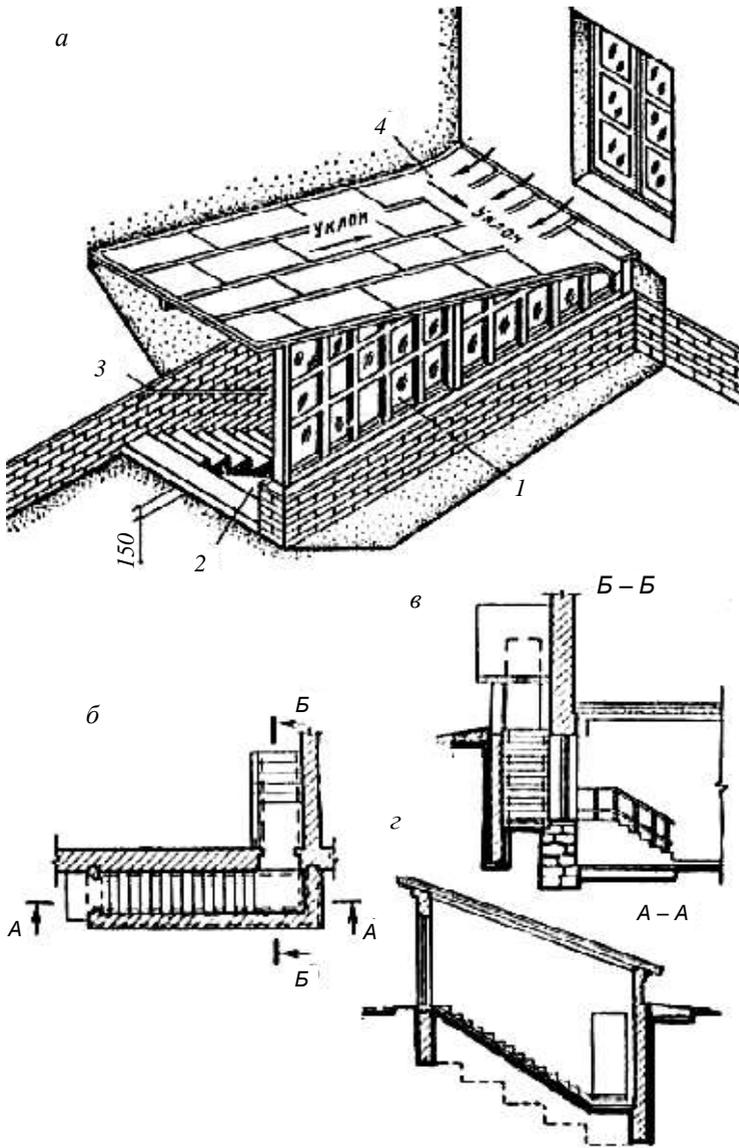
Наружный вход в подвал: а — общий вид; б — план;
